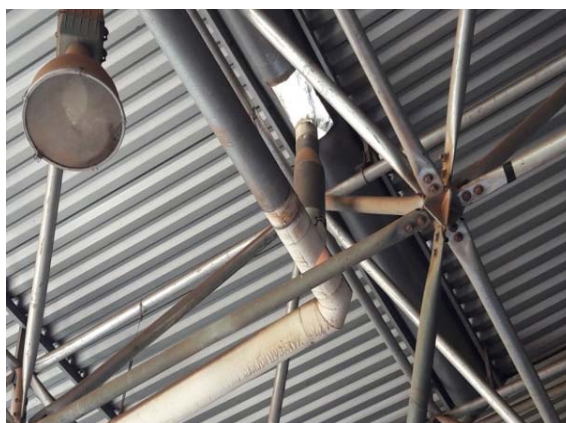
Detalhe das calhas de coleta do telhado.
